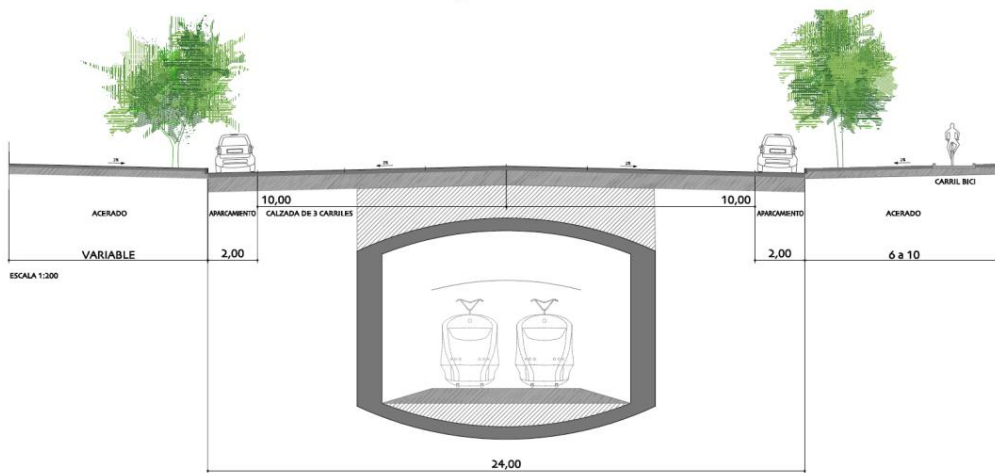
Propuestas de actuación en la calle Luis Rosales. Fuente: PGOU de Sevilla
